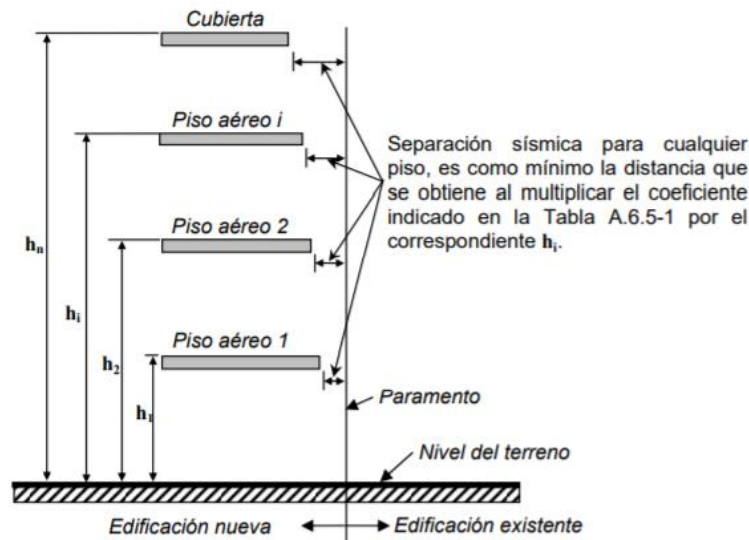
Separación sísmica de cubiertas entre edificaciones A.6.5.1
